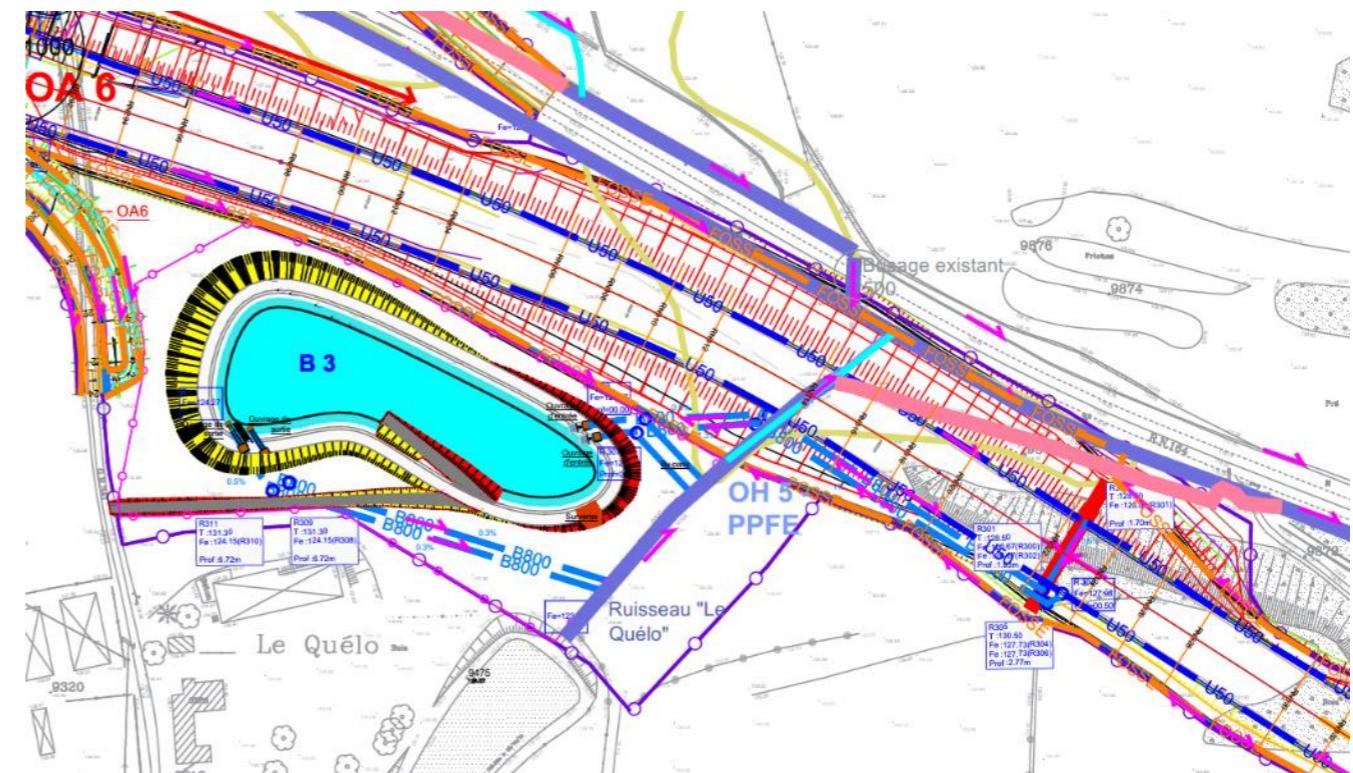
Plan d'assainissement du BR3 (source : SIR)
